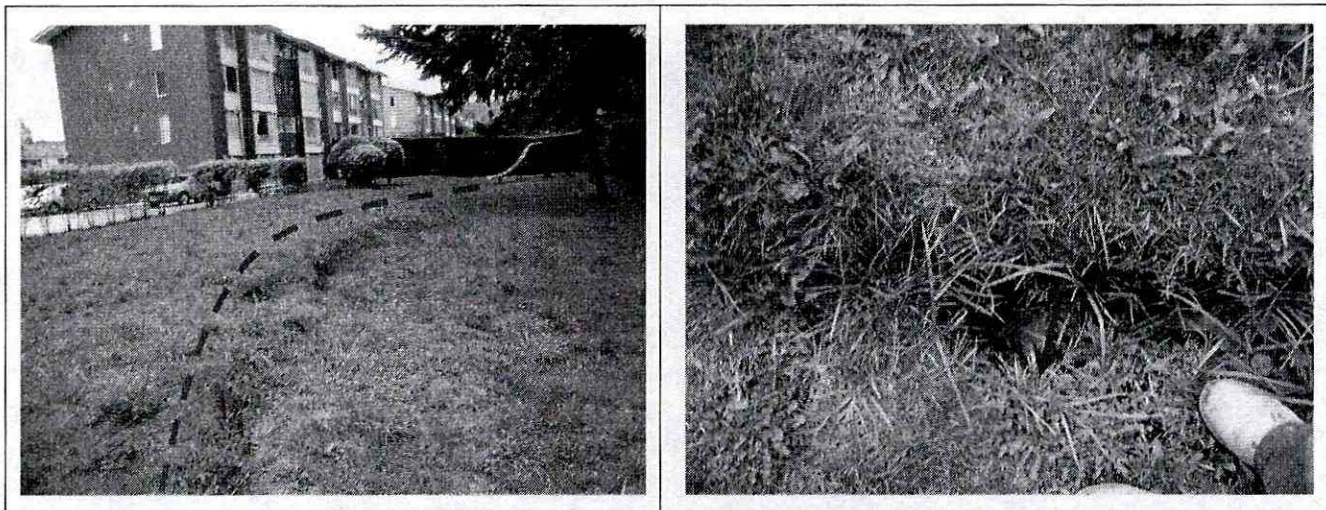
y 6. agrietamiento evidenciado sobre la zona verde del Conjunto Residencial Santa Helena 8
